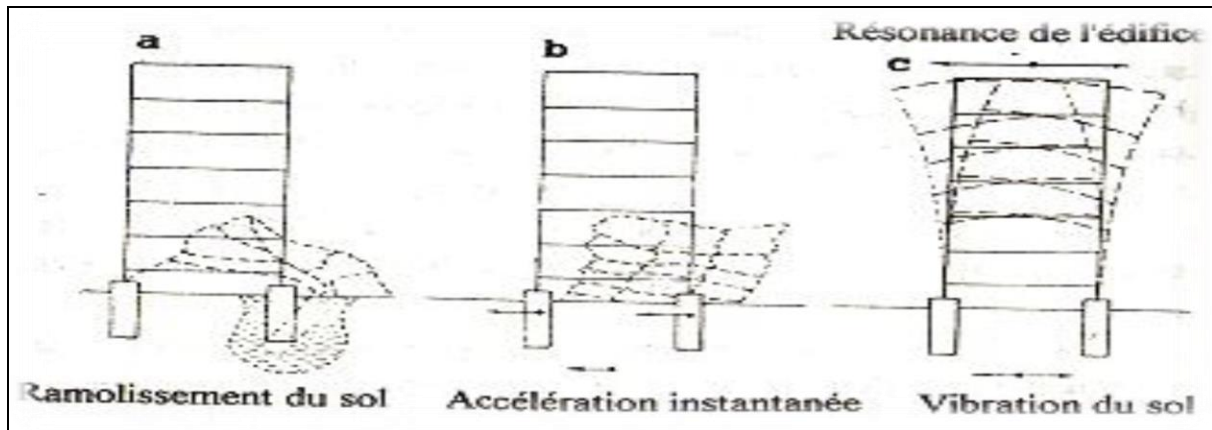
Trois causes principales de destruction des constructions pendant les séismes.
